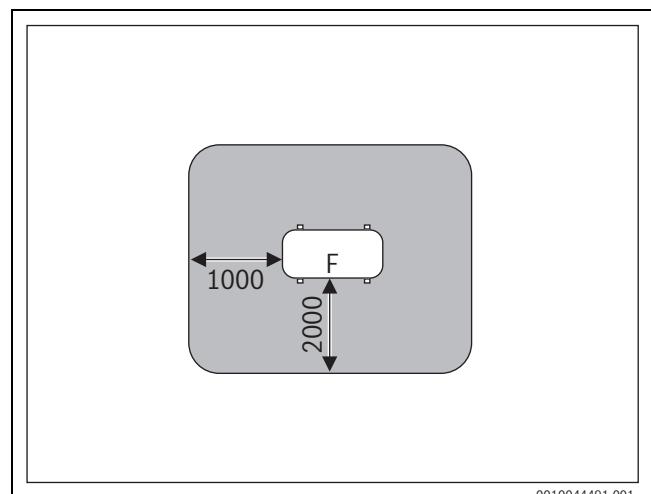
Schutzbereich bei Aufstellung auf dem Boden auf dem Grundstück oder Dach (Maße in mm)
